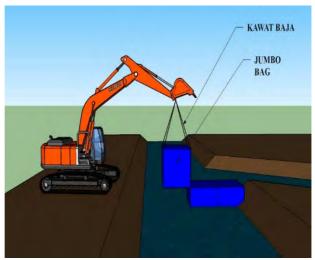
39. *Jumbo bag* dan *steel sheet pile* telah terpasang di bendung pengelak hulu
